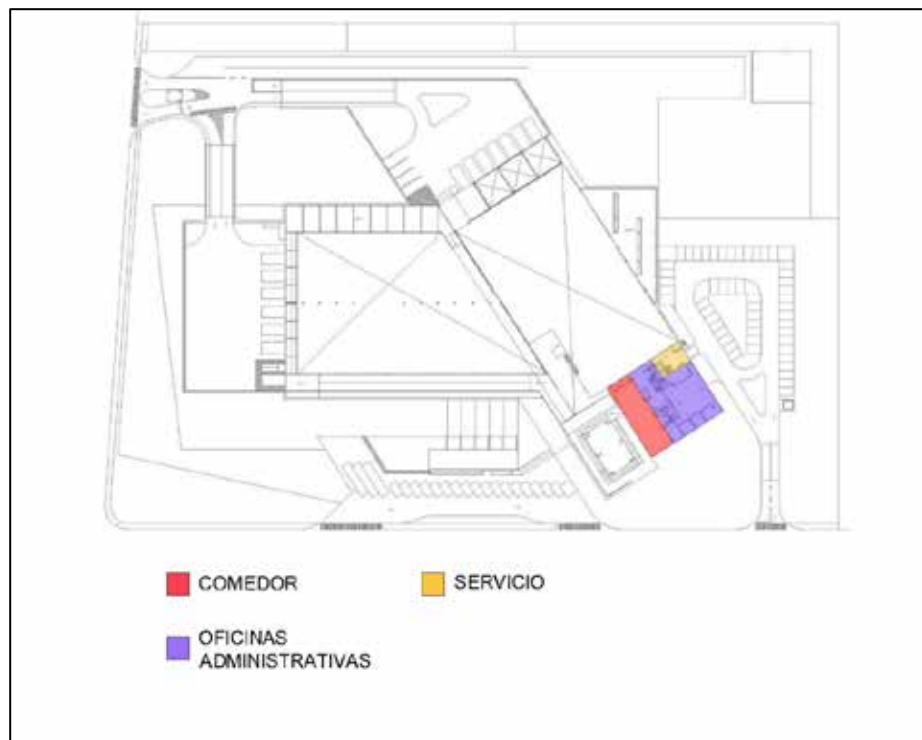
Planta piso 1 Nivel +5.50. (2015)
